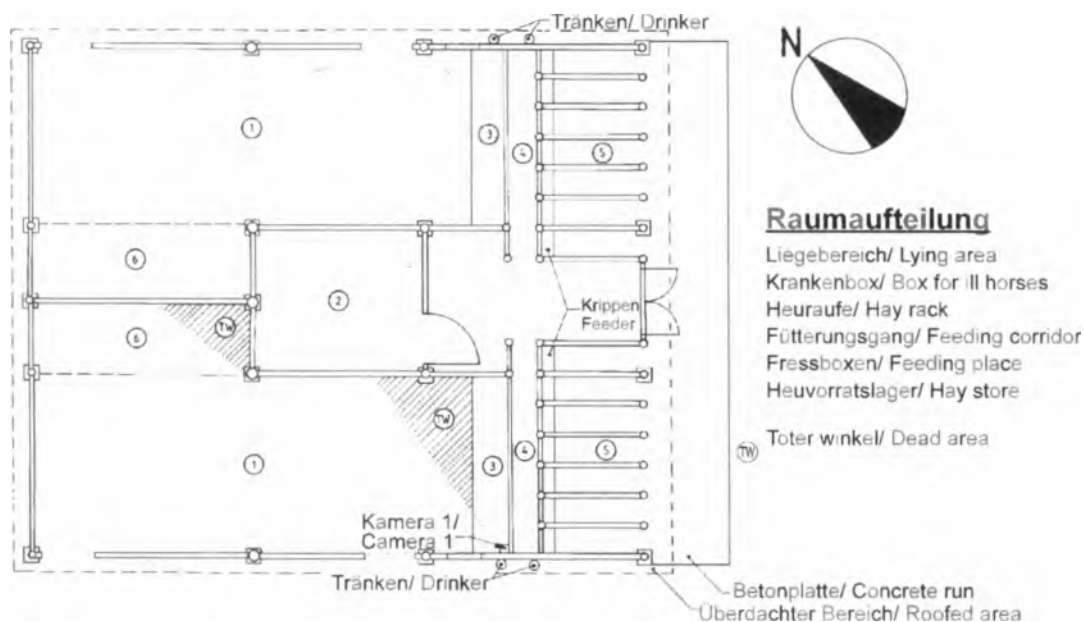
Gruppenauslaufhaltung: Grundriß des Stallgebäudes in Betrieb A
